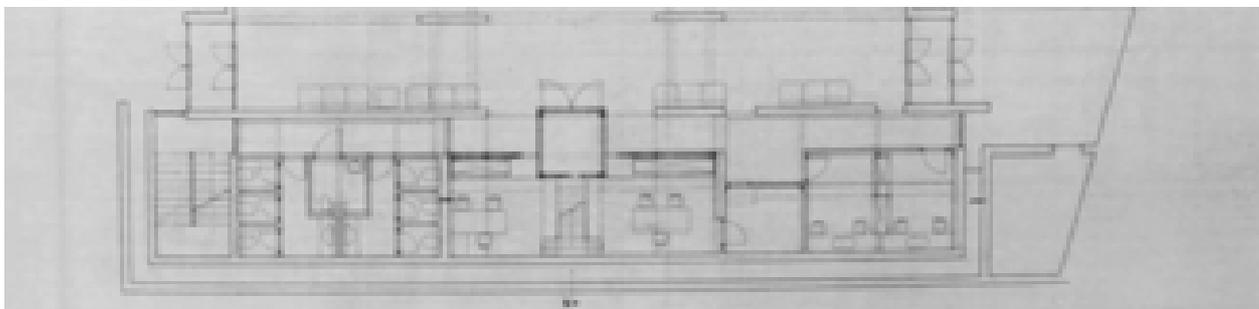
Planimetria generale, opere di completamento – 22/04/1997 (AABS-497)
